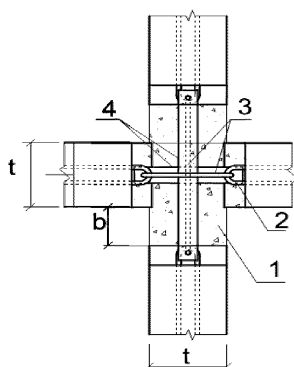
Соединение четырех панелей: 1 – бетон замоноличивания; 2 – петлевые арматурные выпуски; 3 – соединительные скобы; 4 – соединительная пластина; b – 100–120 мм; t – толщина стены (140–250 мм)
